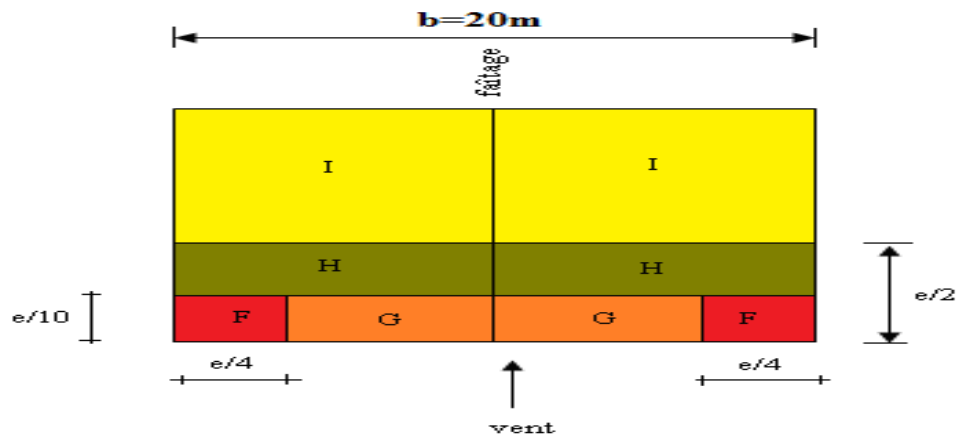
Vue en plan des zones de pression sur la toiture suivant le pignon
